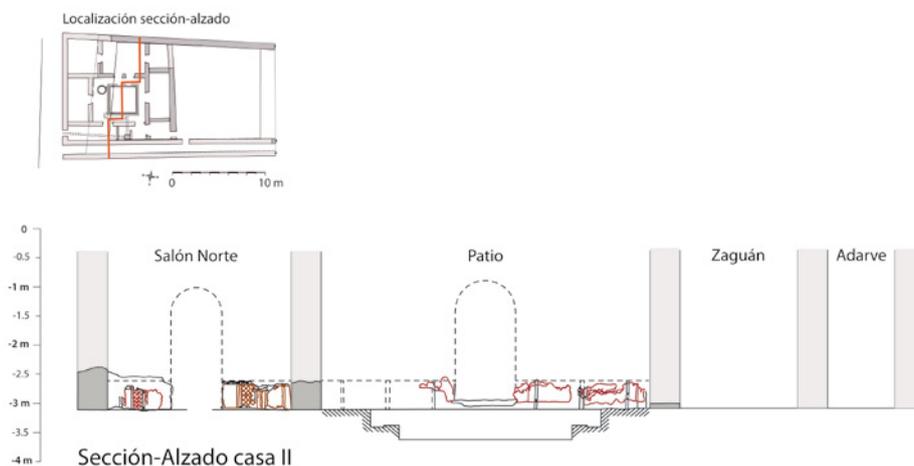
Sección y alzado norte-sur de la vivienda II (PPF).
